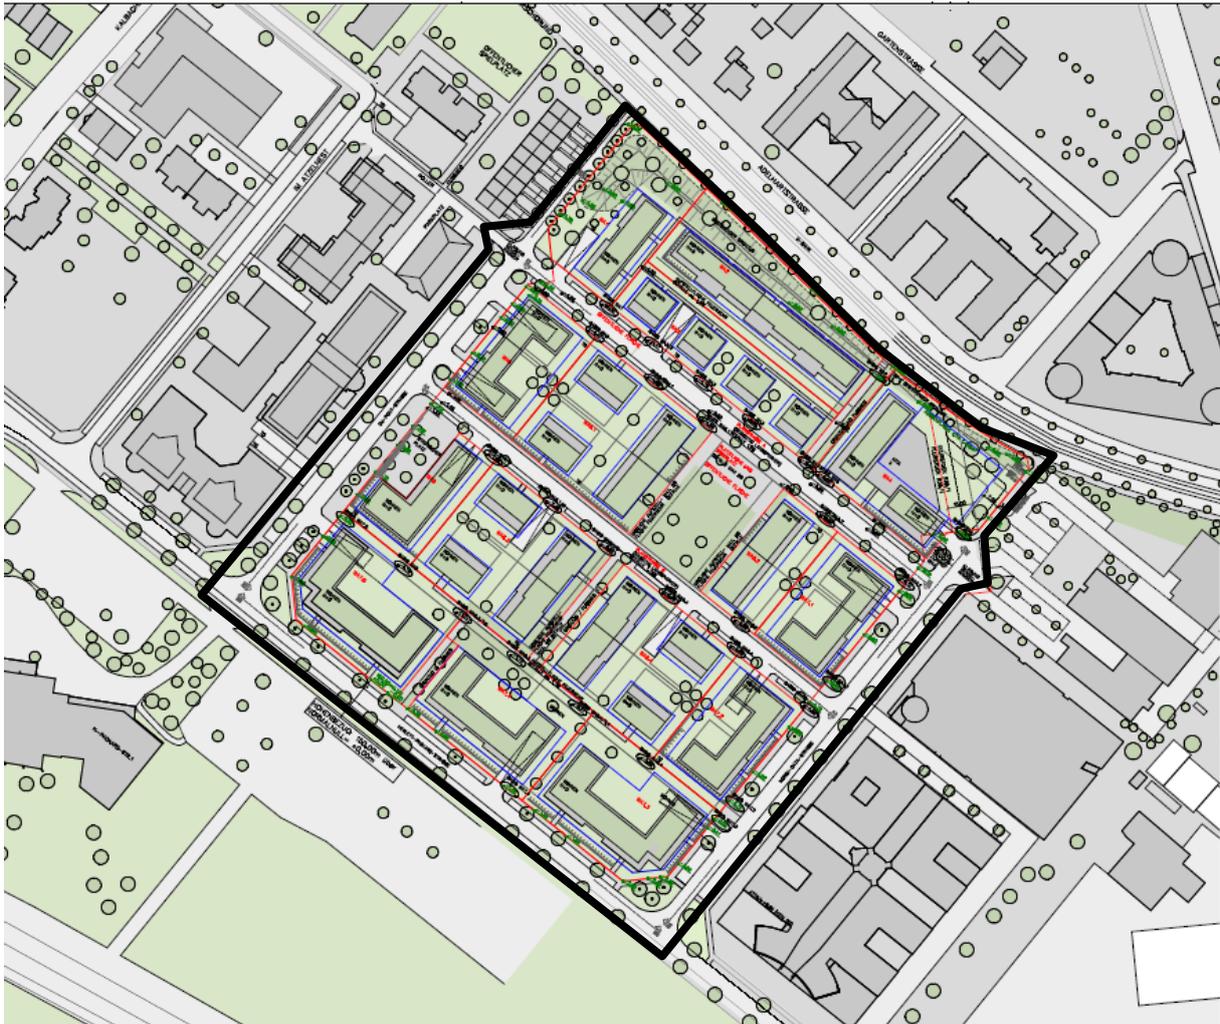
Städtebauliches Konzept/Lageplan (ohne Maßstab)¹³
